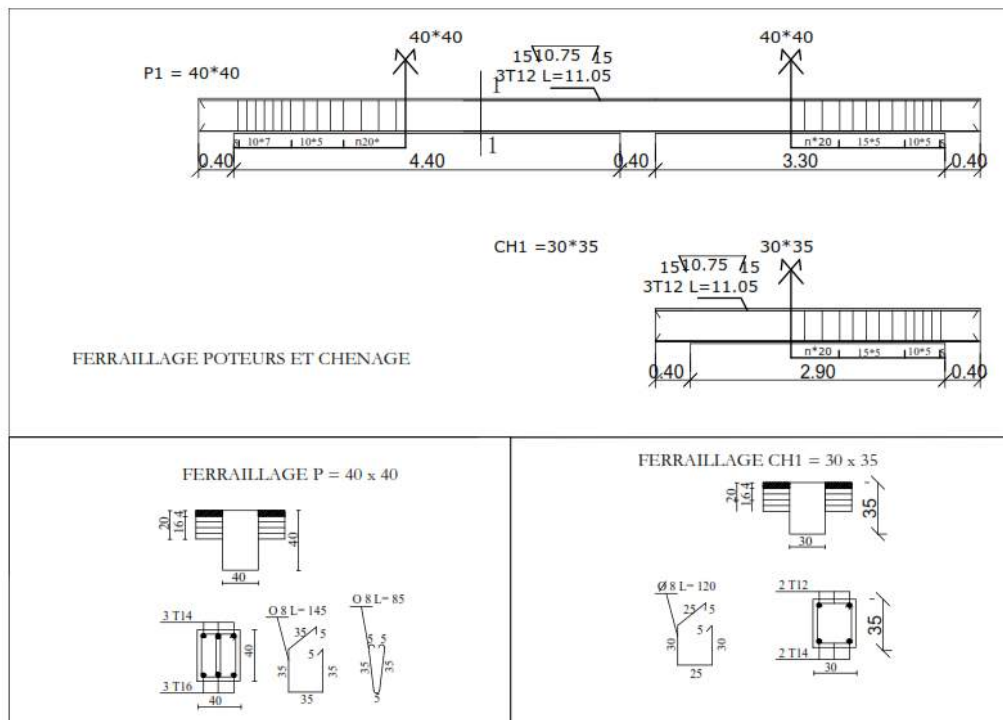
Ferrailage de la poutre principale (30x40) et poutre secondaire (30x35).
